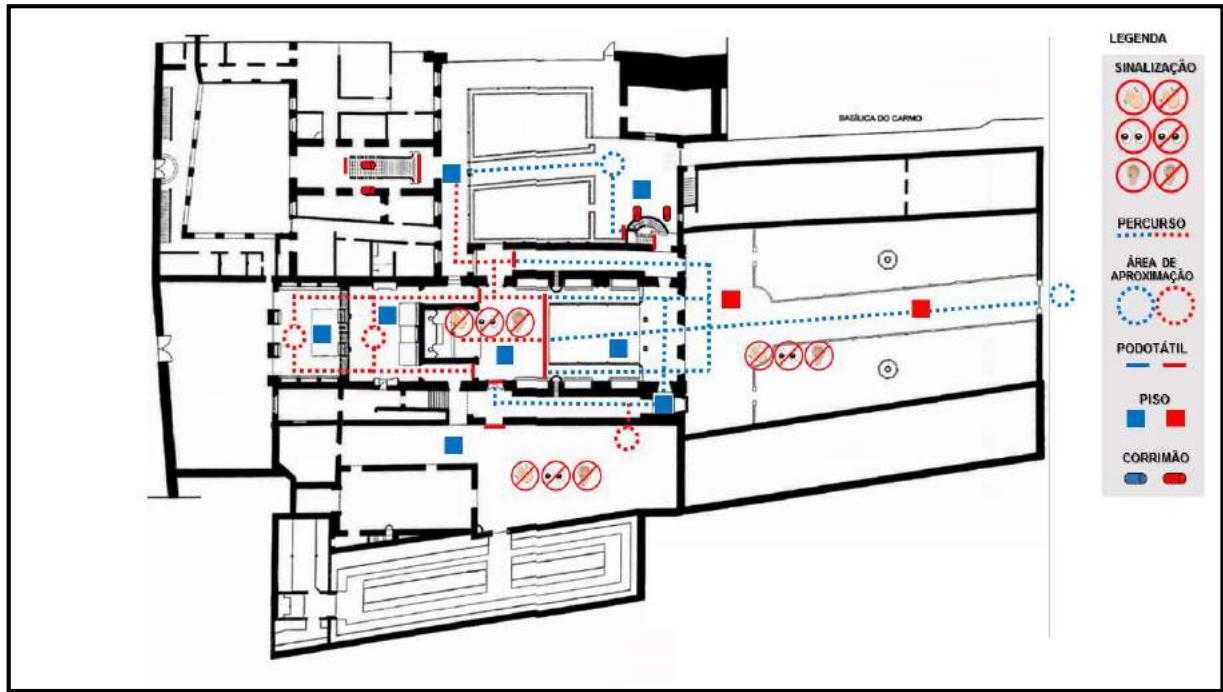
Planta Baixa do pavimento superior da Igreja da Ordem Terceira do Carmo. Fonte: INBMI - IPHAN. 2015.
